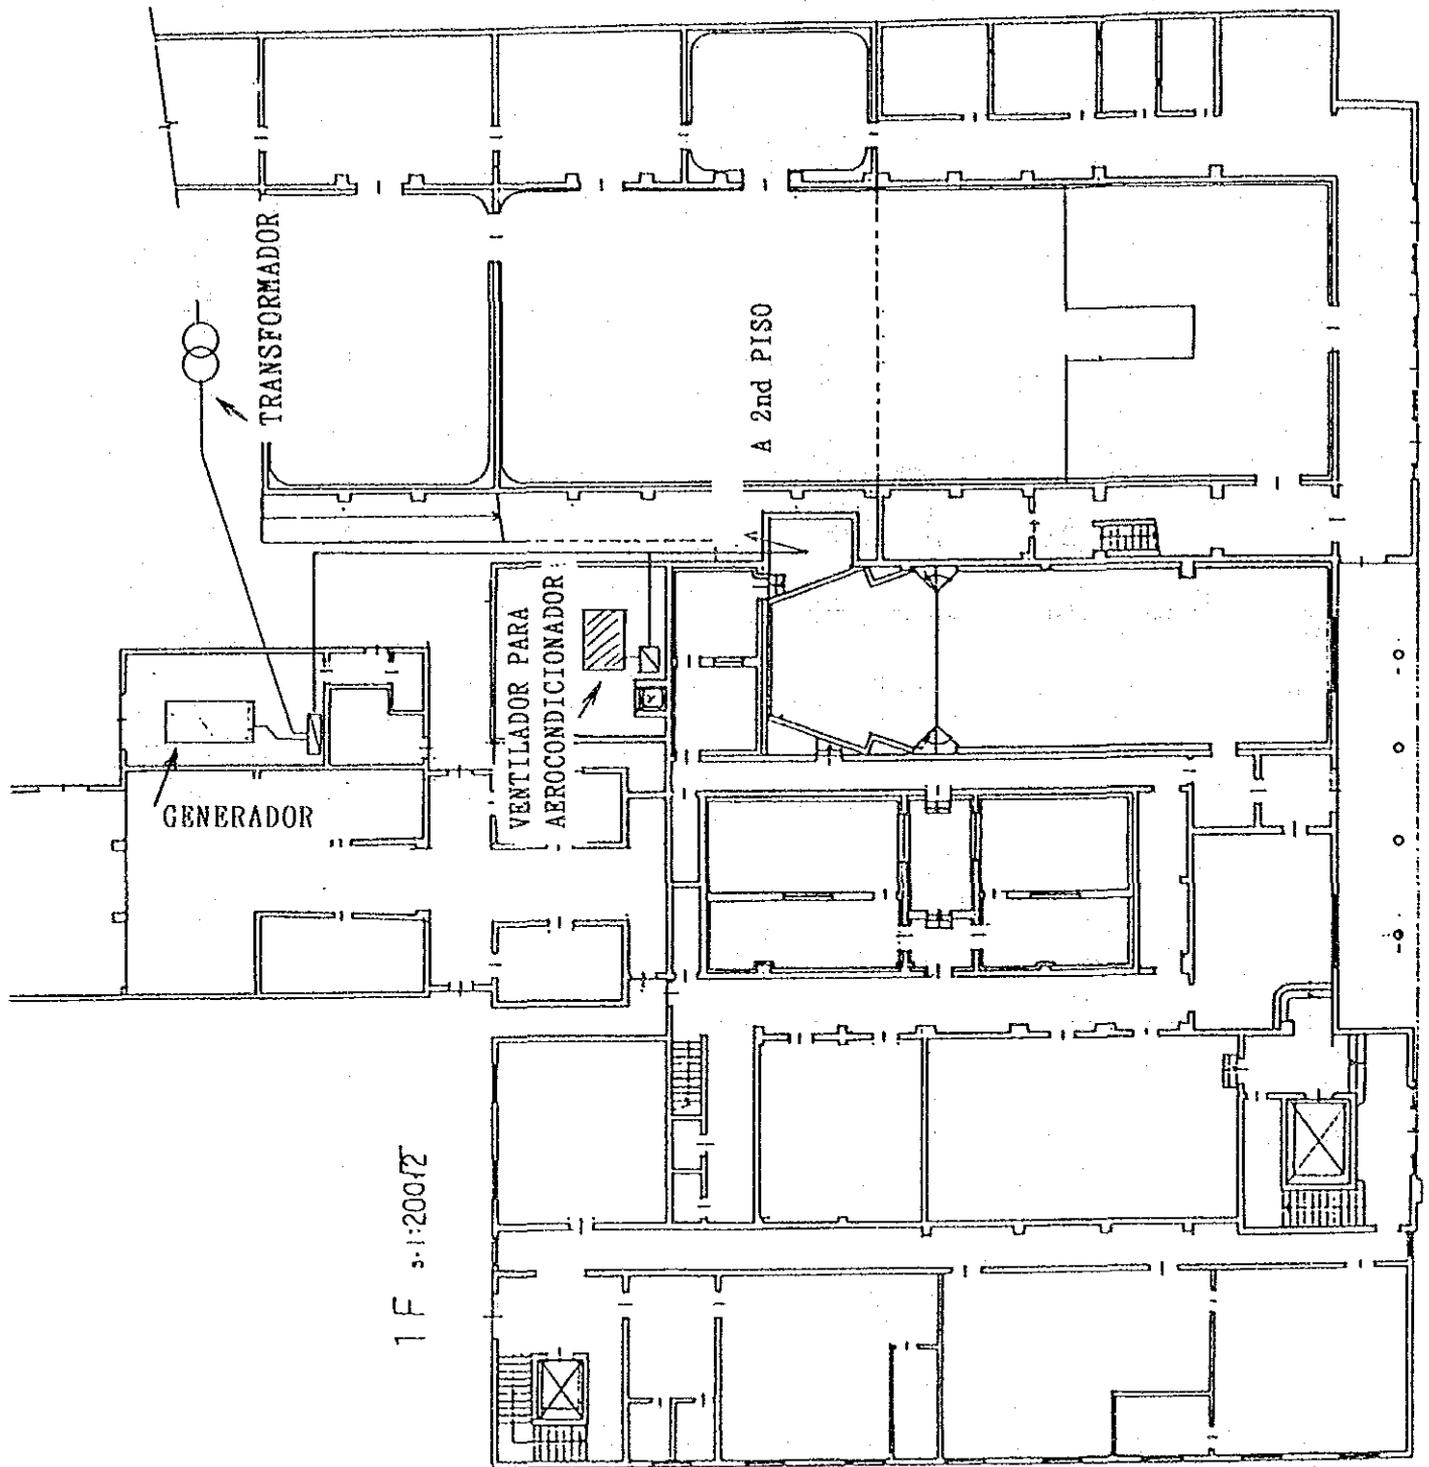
PLANO DE LAS RUTAS DE CABLES DE LA ENERGIA ELECTRICA
